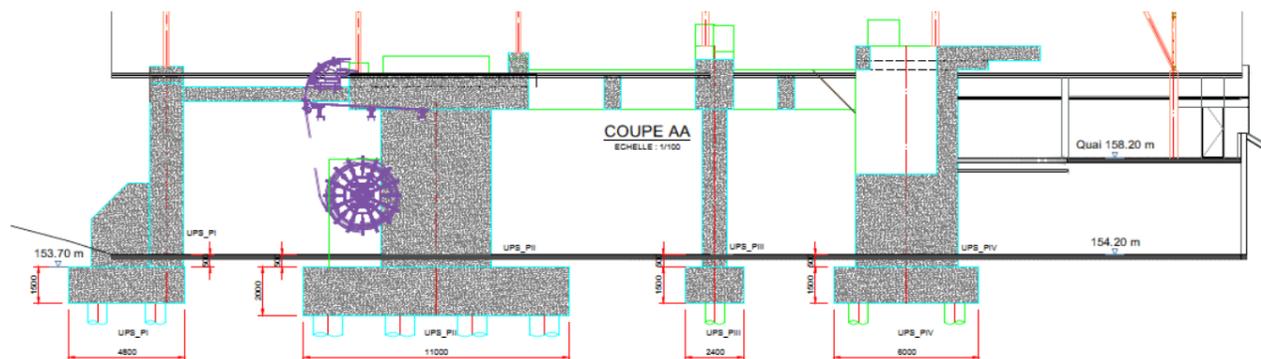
Coupe de la station UPS et fondations (source : Groupement POMA, 2018)
